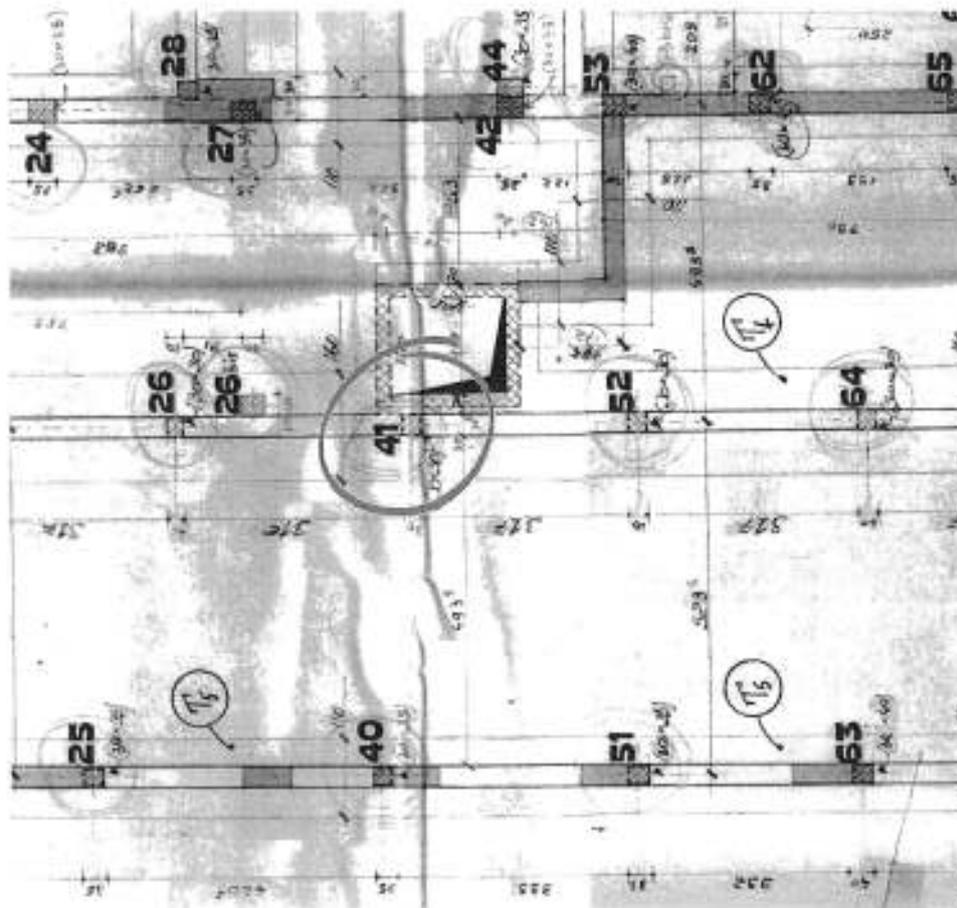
TAV. 1 – pianta fondazioni (particolare intorno al vano ascensore)
